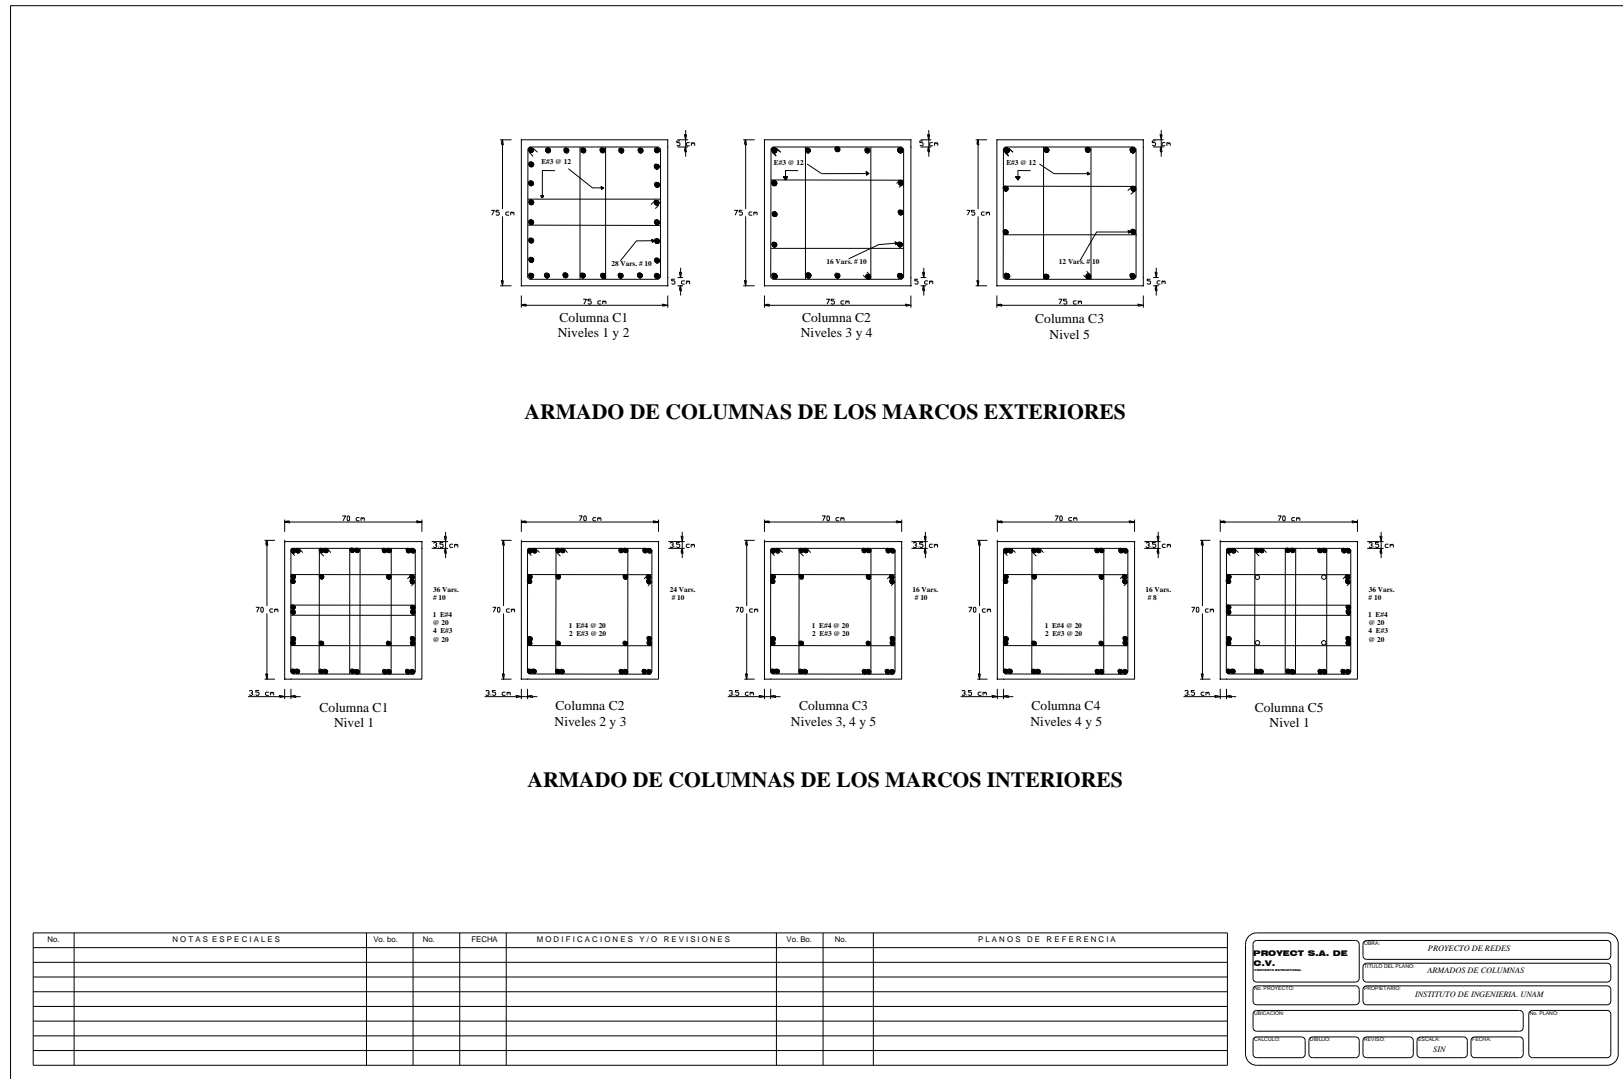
Detalles estructurales del edificio de 5 niveles diseñado con el RCDF-04
